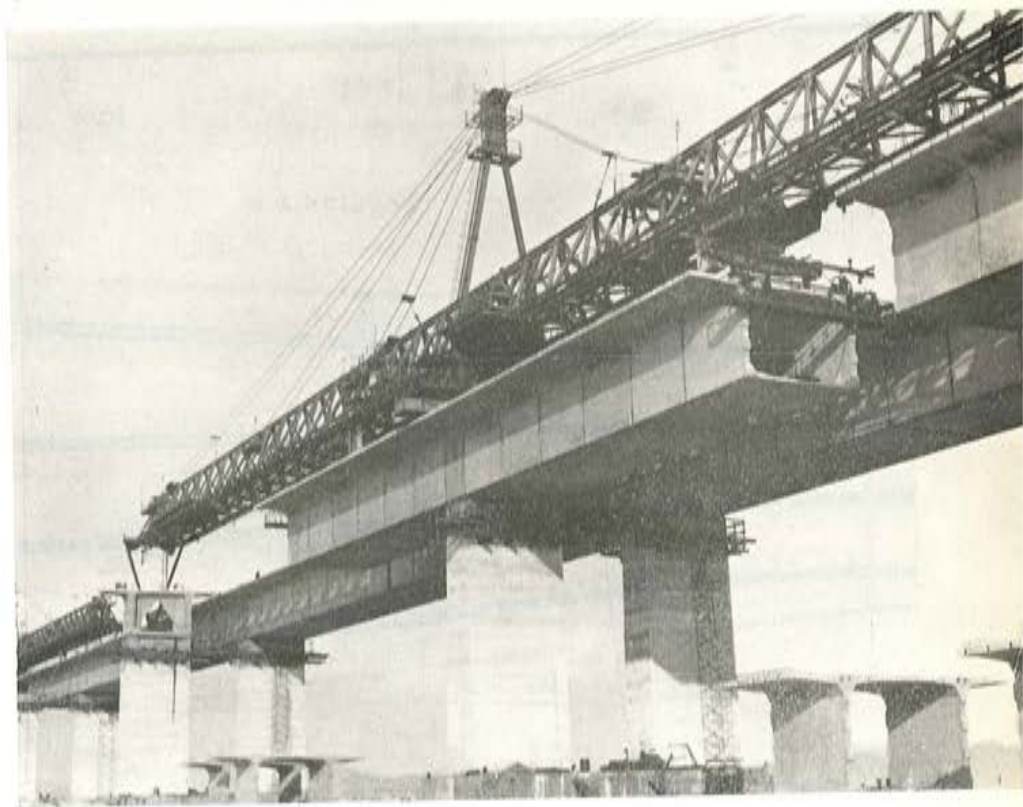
Detalles del apoyo de la viga de lanzamiento.
